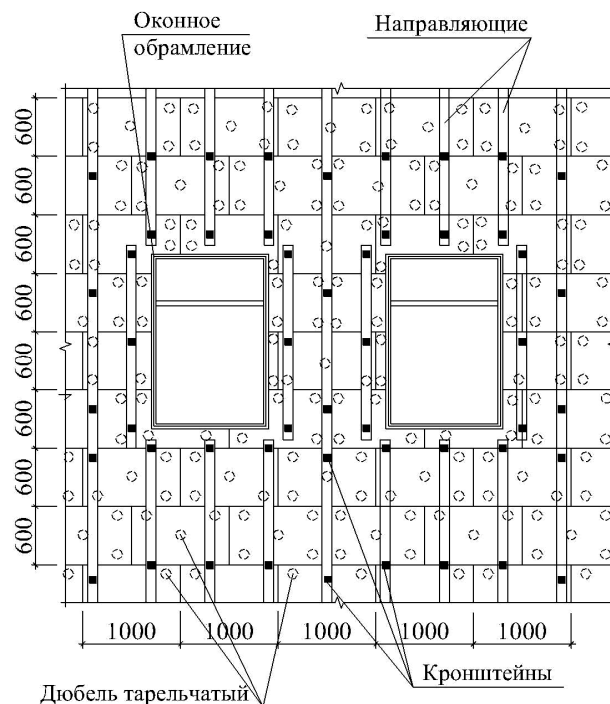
Принципиальная схема установки плит утеплителя и элементов подоблицовочной конструкции навесной фасадной системы «Newton Systems» для облицовки плитами керамогранита с видимым креплением
